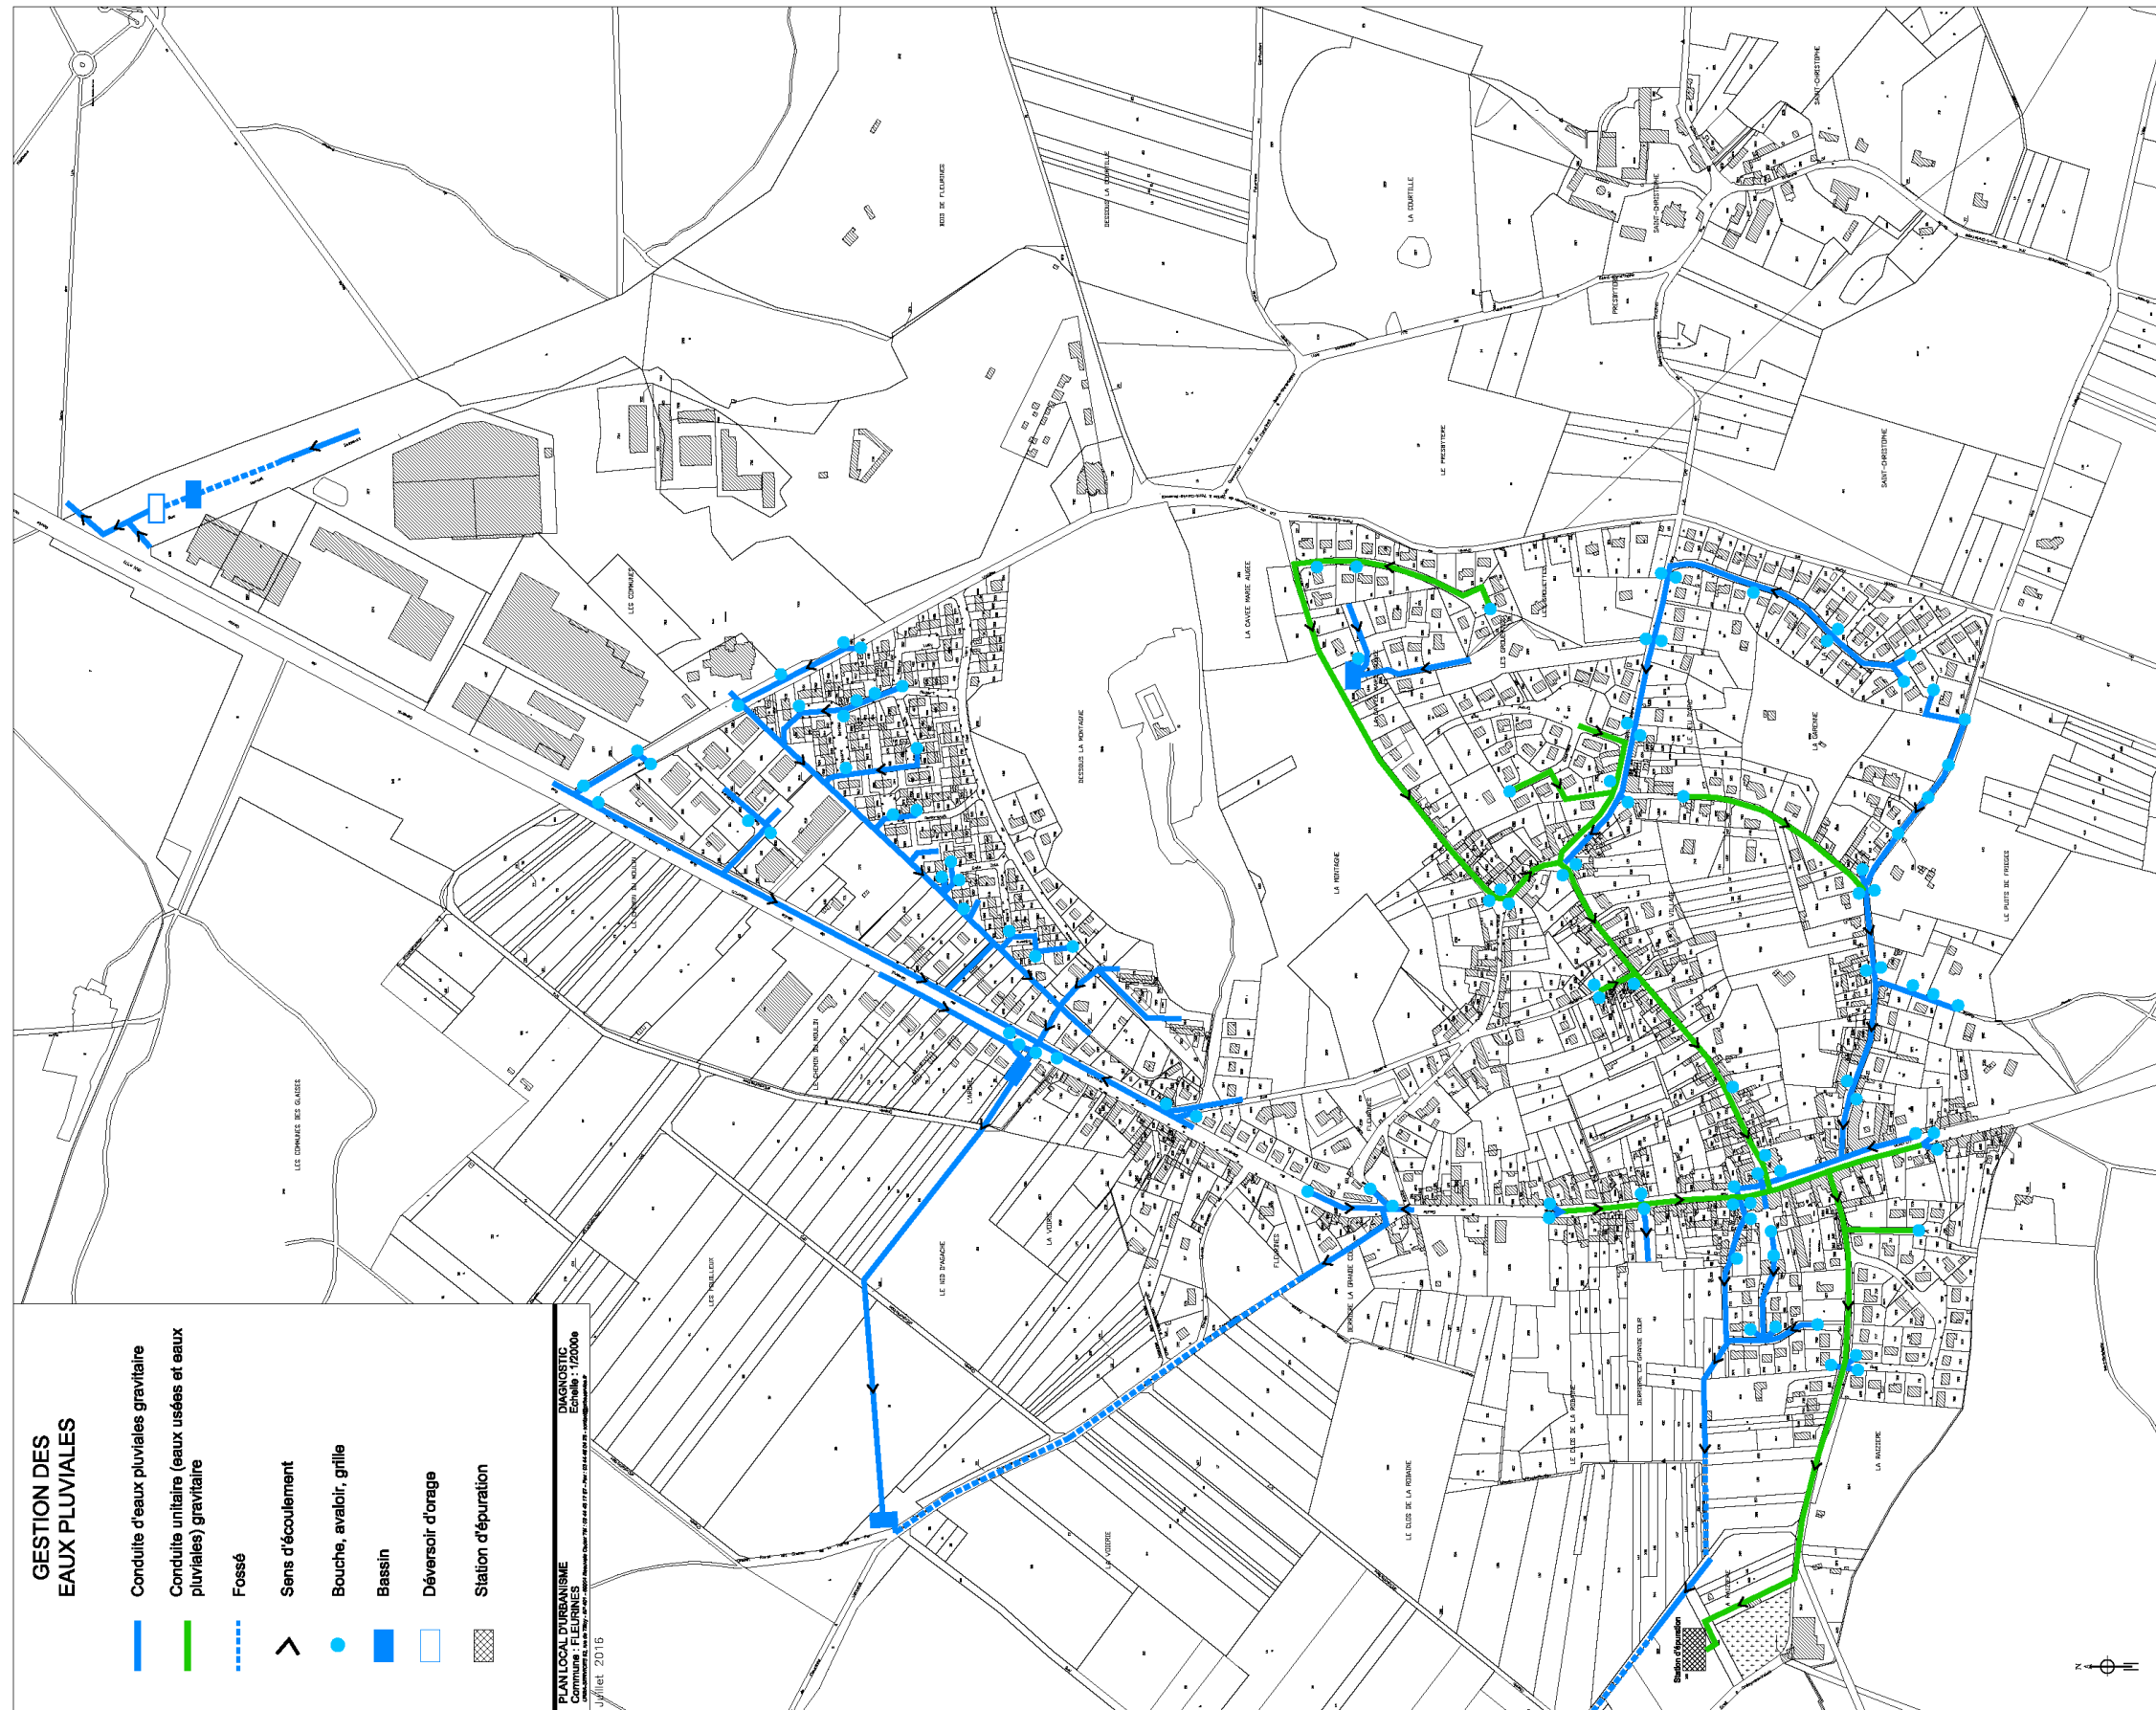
Réseau d' assainissement des eaux pluviales de la commune
